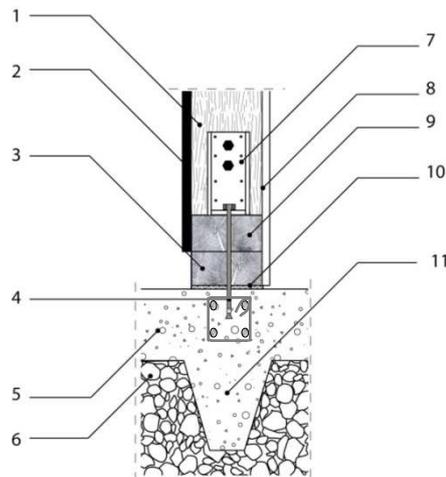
Coupe de principe : Détail d'ancrage de la lisse basse d'un mur extérieur avec plancher bas en bois : panneaux de contreventement murs VT (diaphragme : par panneau voile travaillant)
